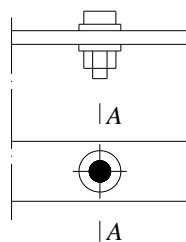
Расположение проверяемого на выносливость расчетного сечения А – А по основному металлу в сечениях нетто у отверстия с поставленным в него высокопрочным болтом, затянутым на нормативное усилие
